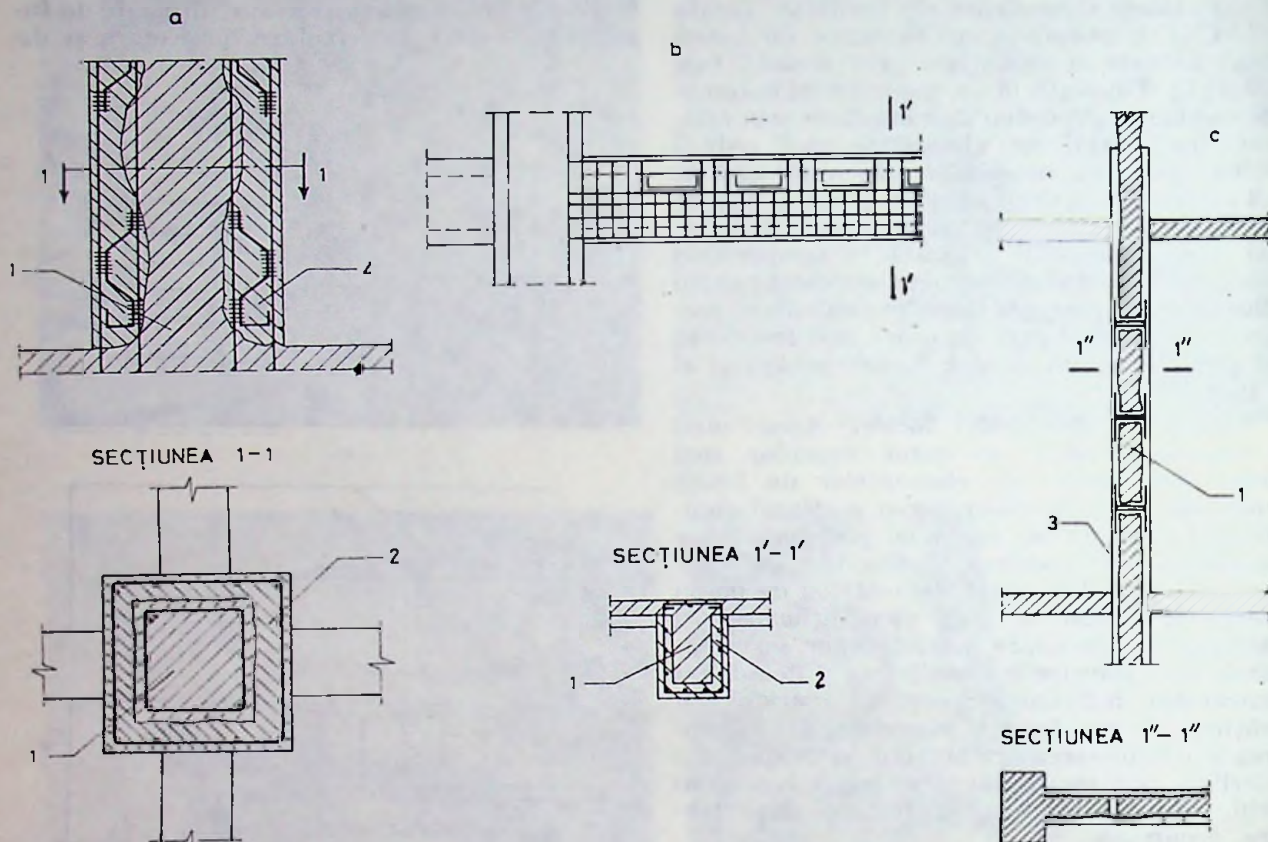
Cămășuirea elementelor de beton armat; a — Cămășuirea unui stîlp; b — Cămășuirea unei grinzi; c — Cămășuirea unei diafragme; 1 — beton existent; 2 — cămășuială; 3 — beton torcretat armat cu plasă \varnothing 6 mm la 10 cm.
